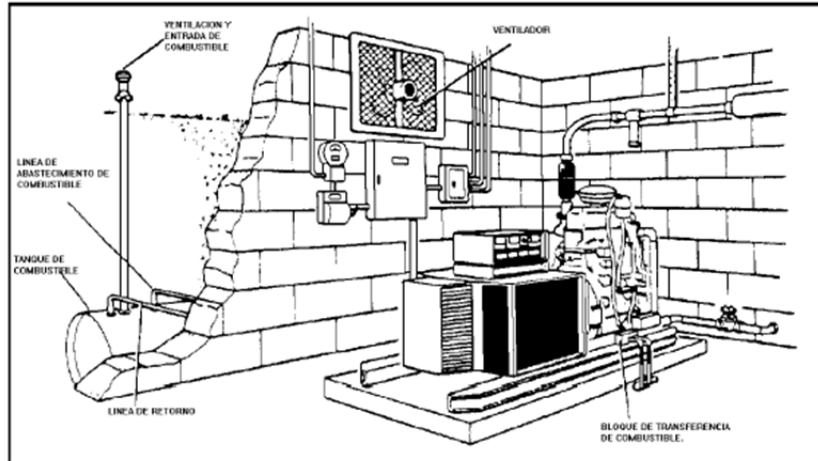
VISTA DE UNA PLANTA DE EMERGENCIA
